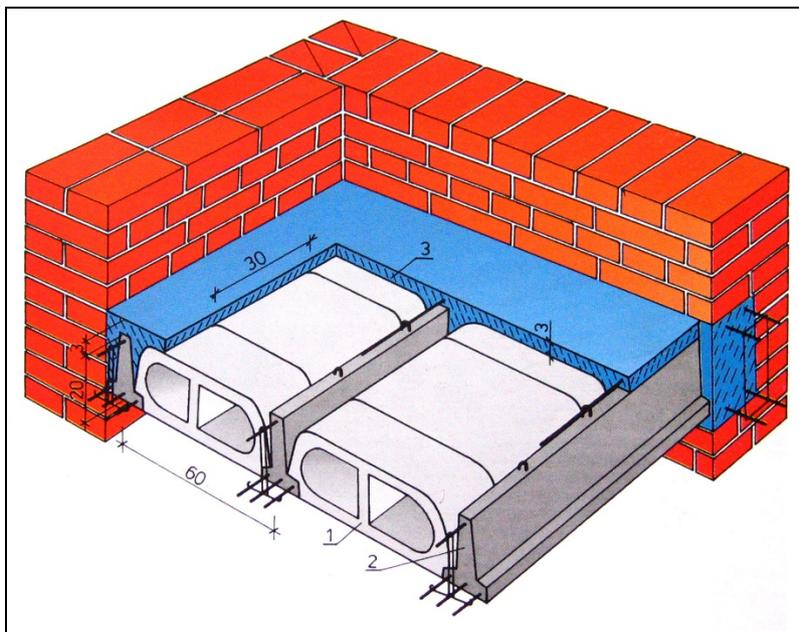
Сборно-монолитное балочное перекрытие, размеры даны в сантиметрах; 1 – двухпустотный бетонный вкладыш, 2 – сборная железобетонная тавровая (с полками для опирания вкладышей) балка; 3 – монолитный бетон [11, Рис. 4–10]
